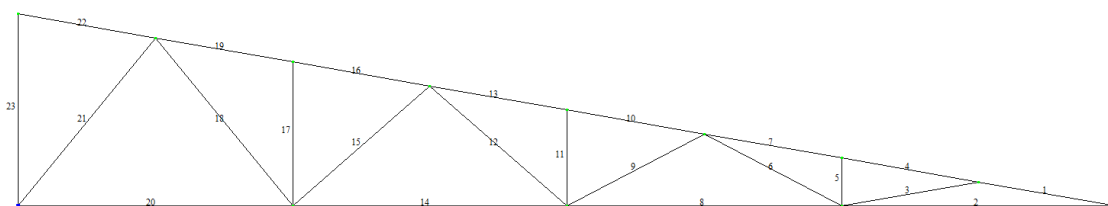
Конечные элементы стропильной фермы Ф1
